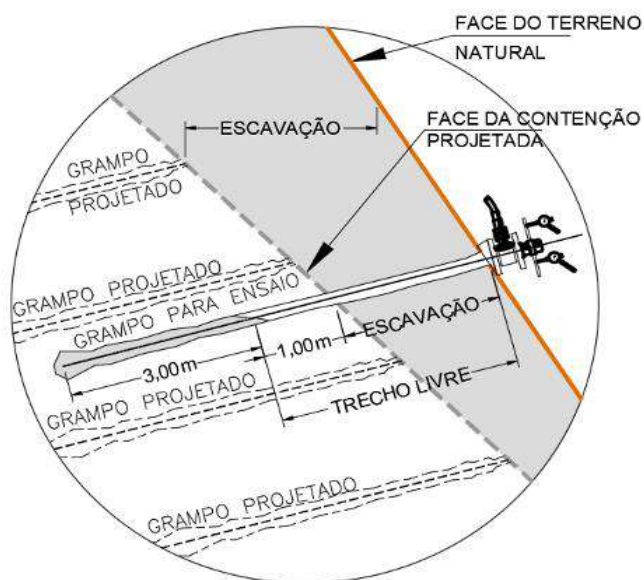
1 – Croqui do arranjo do ensaio de arrancamento.
